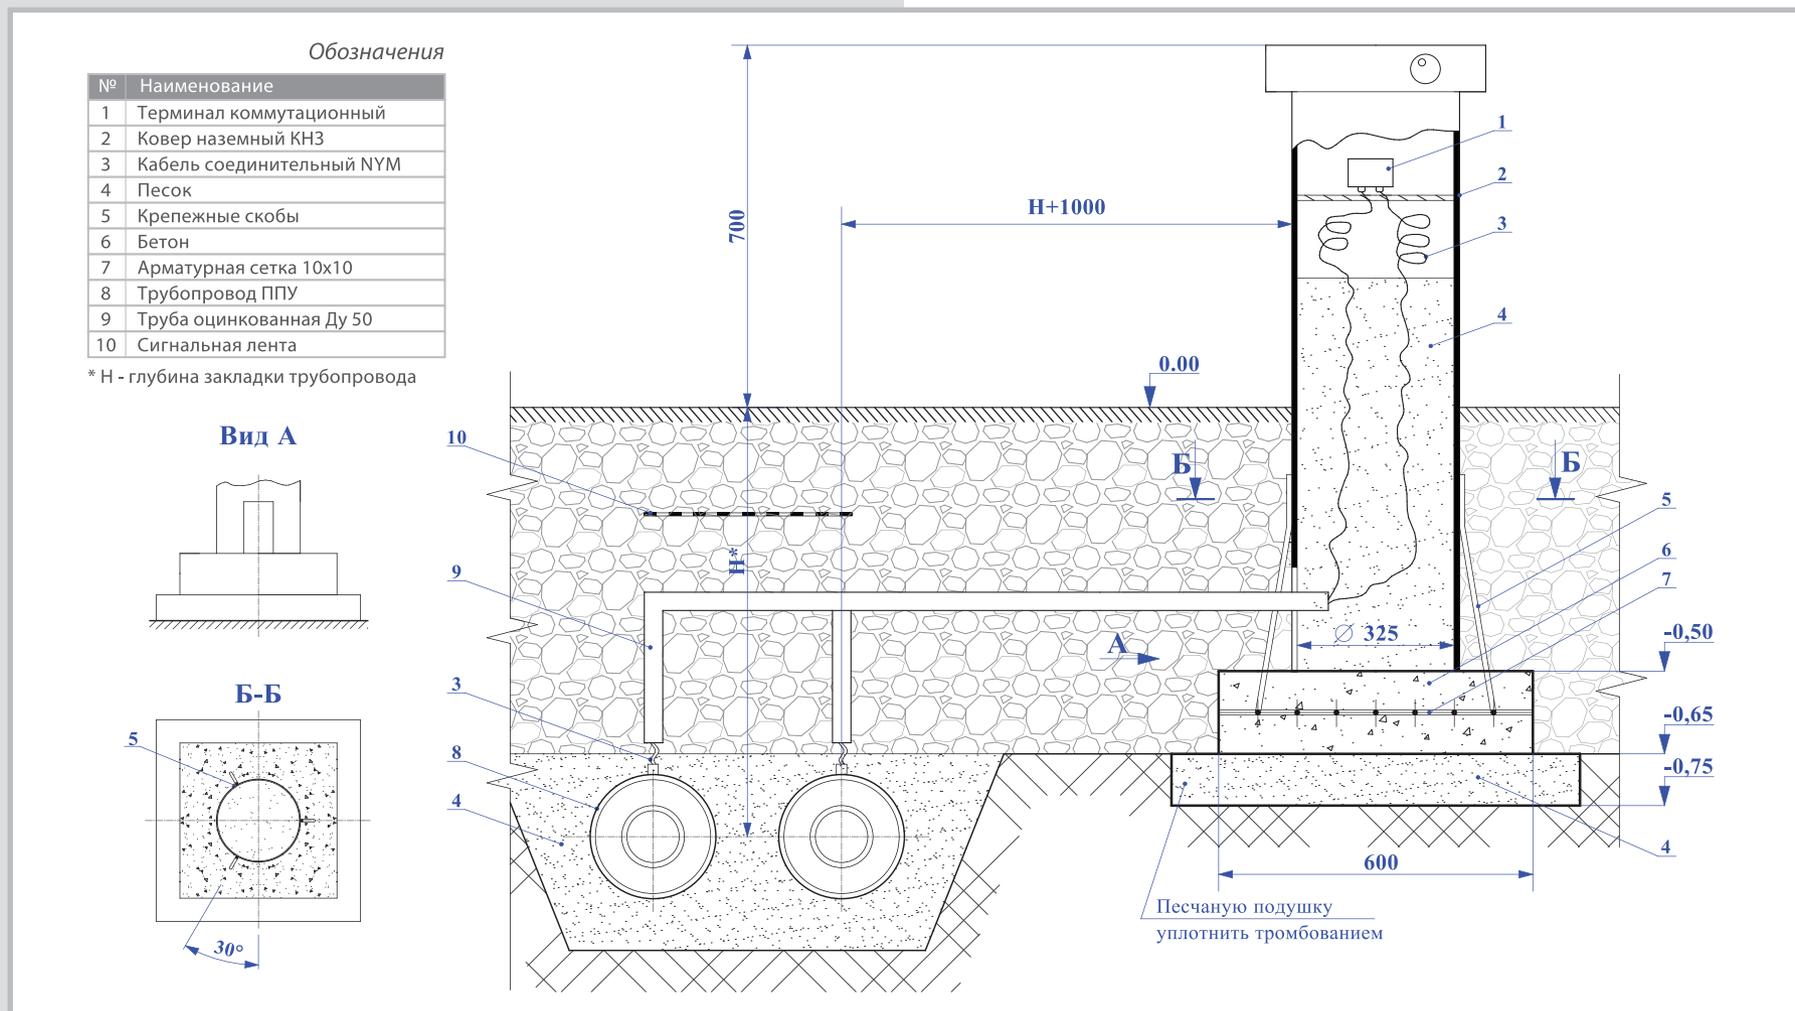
Монтажная схема установки ковра наземного КНЗ в промежуточной ТК без тепловой камеры
